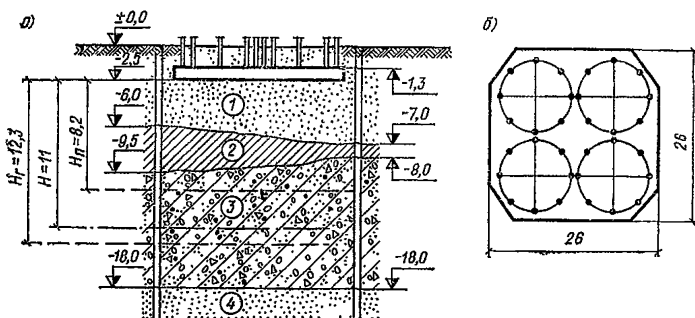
Схемы геологического разреза (а) и плана фундаментной плиты (б) к примеру расчета деформаций основания
